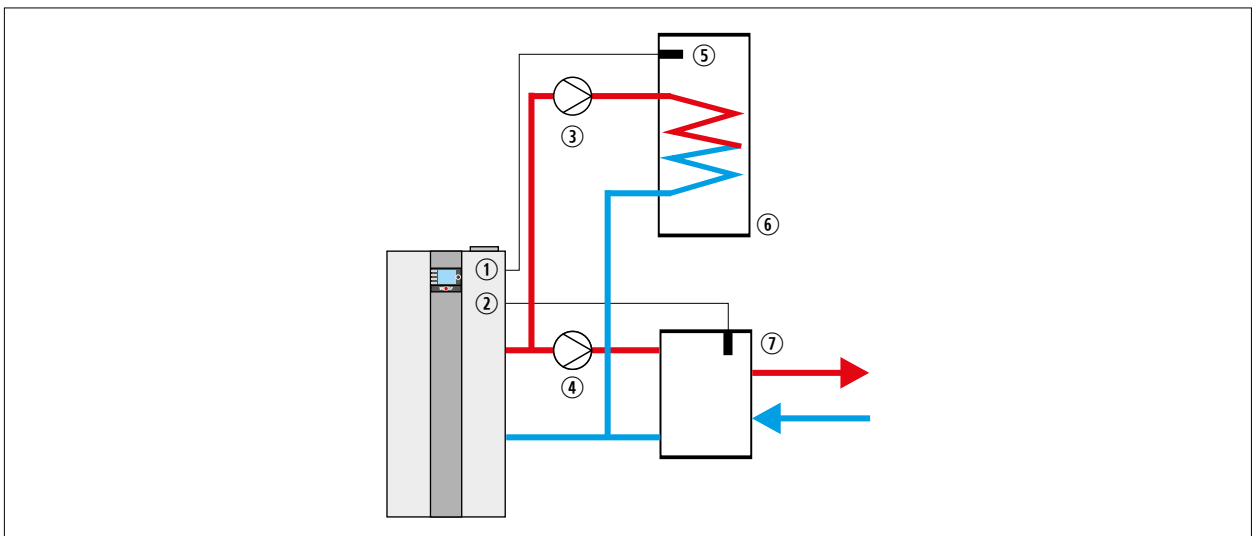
Konfiguracja instalacji 11 – sprężem hydrauliczne / płytowy wymiennik ciepła jako rozdzielacz systemowy
